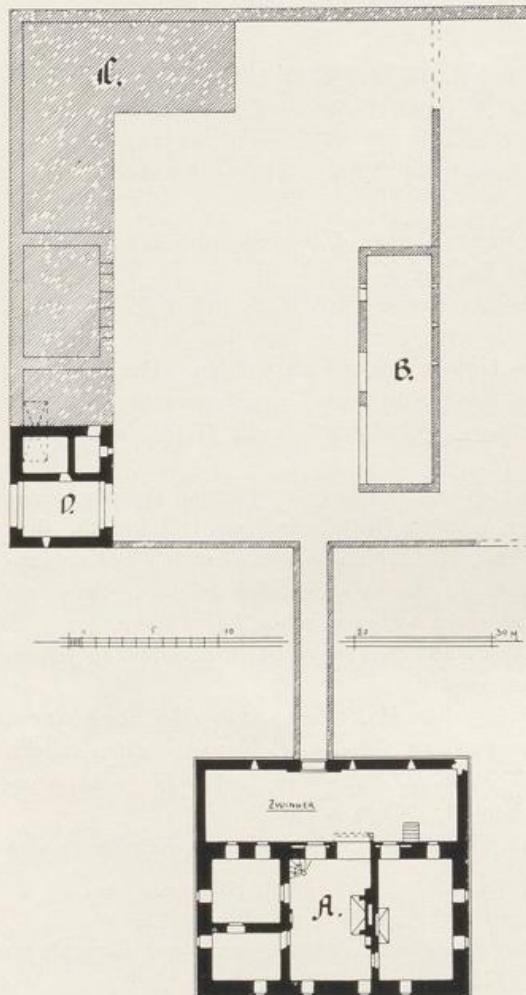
Burg Gödersheim. Grundriss.
